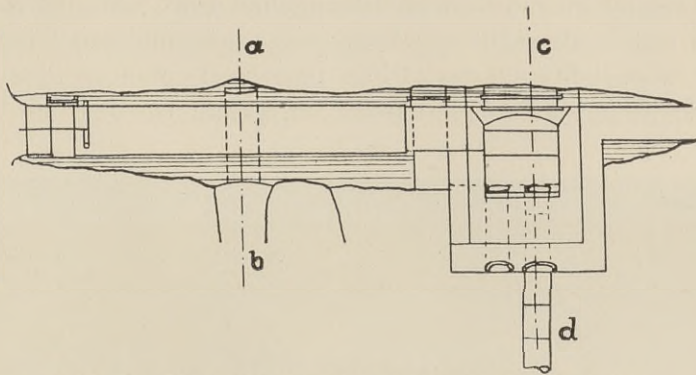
Grundriß der Staumauer. Maßstab 1:400.
